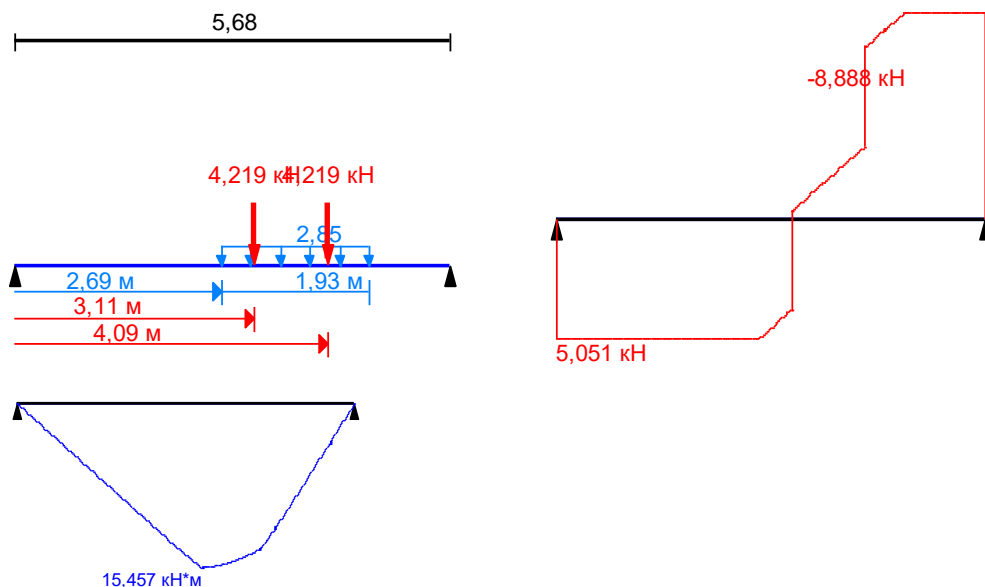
Схема приложения нагрузок от существующего оборудования ОВ и фундаментов Ф в осях 16-19
